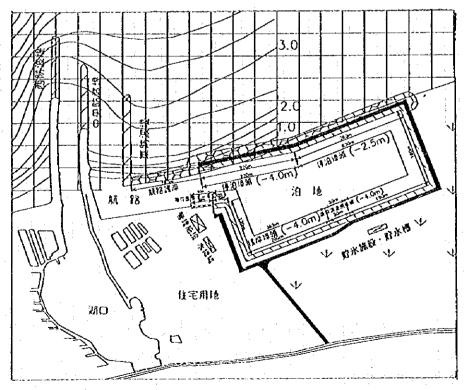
マーディア漁港整備計画平面図 (沿岸漁港開発国家計画)
